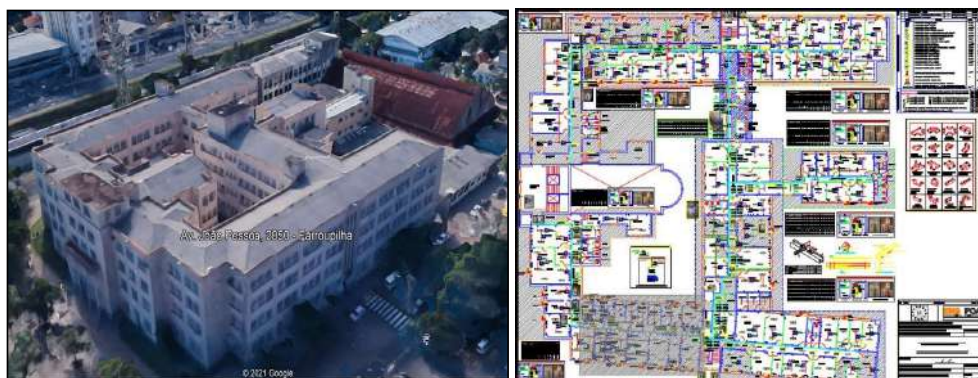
Vistas da fachada da edificação e detalhe da planta baixa do projeto elétrico para adequações das Instalações Elétricas do 3º Pavimento do Palácio da Polícia.
